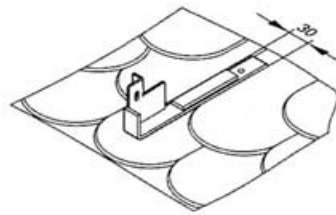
Montage des crochets de fixation sur une toiture en tuiles écaille
